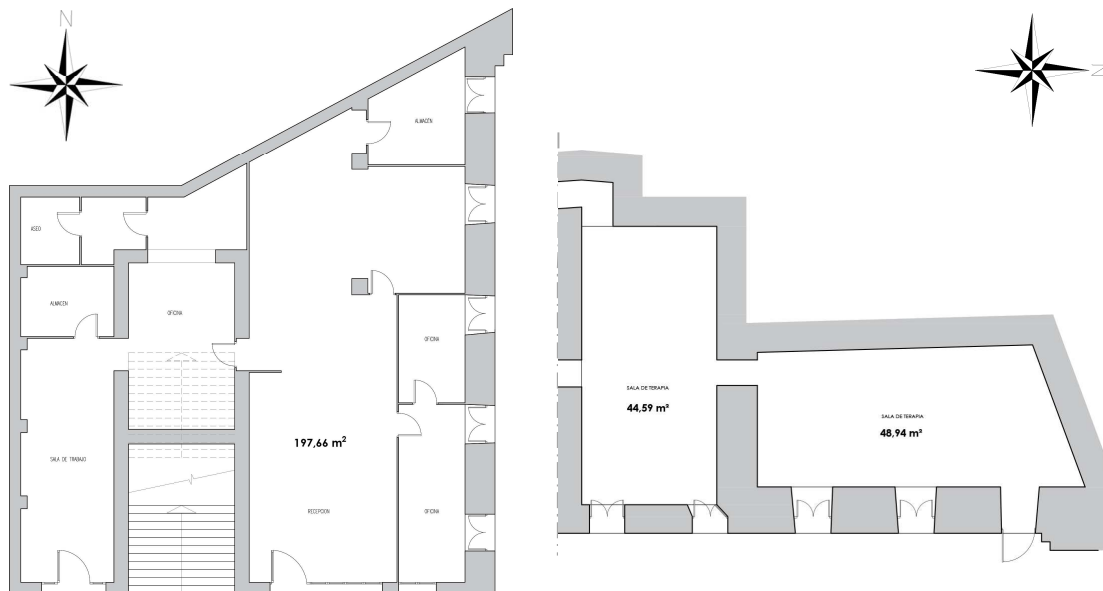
Imagen izquierda – Volumen 1. Planta baja. Imagen derecha – Volumen 1. Planta sótano 1. Fuente: Elaboración propia.
